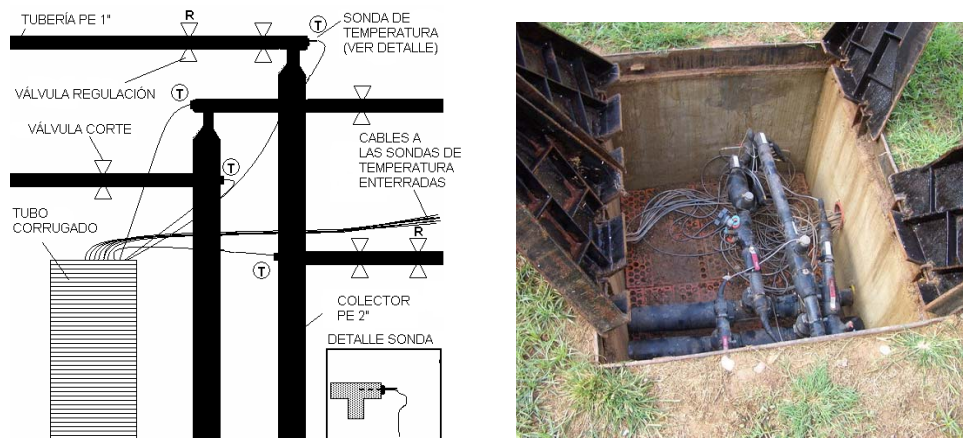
Detalle de la conexión de las tuberías verticales con los colectores horizontales. Elementos ubicados en las arquetas de registro
